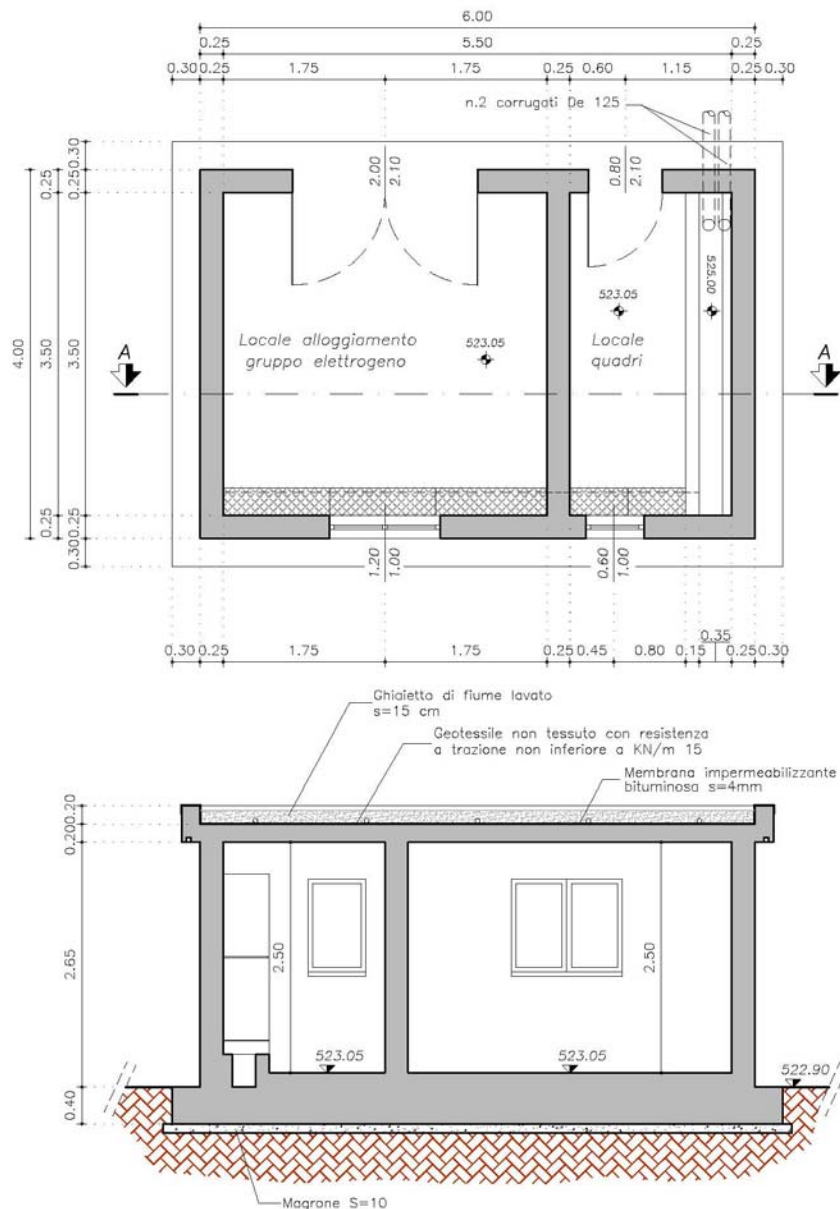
Pianta e sezione nuovo Locale Quadri e Gruppo Elettrogeno
